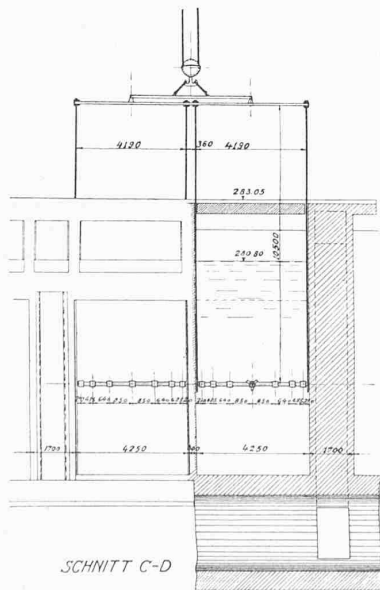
Vertikalschnitt C-D durch den mit der Messvorrichtung ausgerüsteten Kammer-Einlauf. Masstab 1:250.
